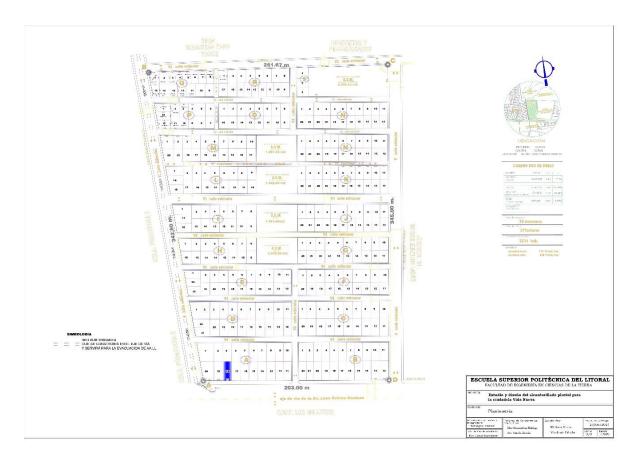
Planimetría 3. Fuente: Elaboración propia
